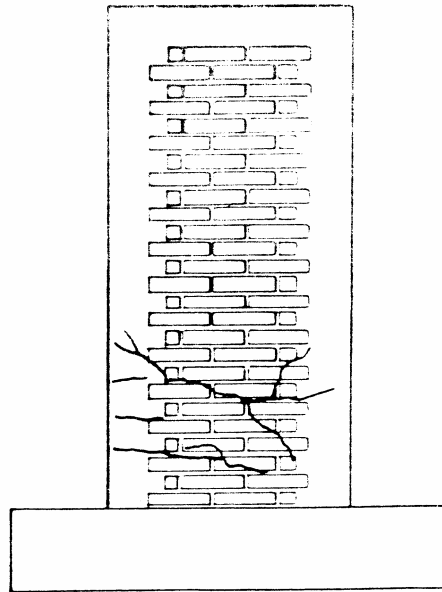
Estado agrietado de muro MRE1 (Diez, 1987)
